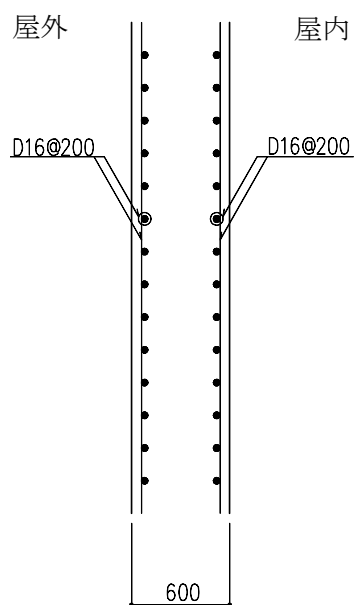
耐震壁の配筋図 (1階, YM通り X1~X2通り間) (単位: mm)
